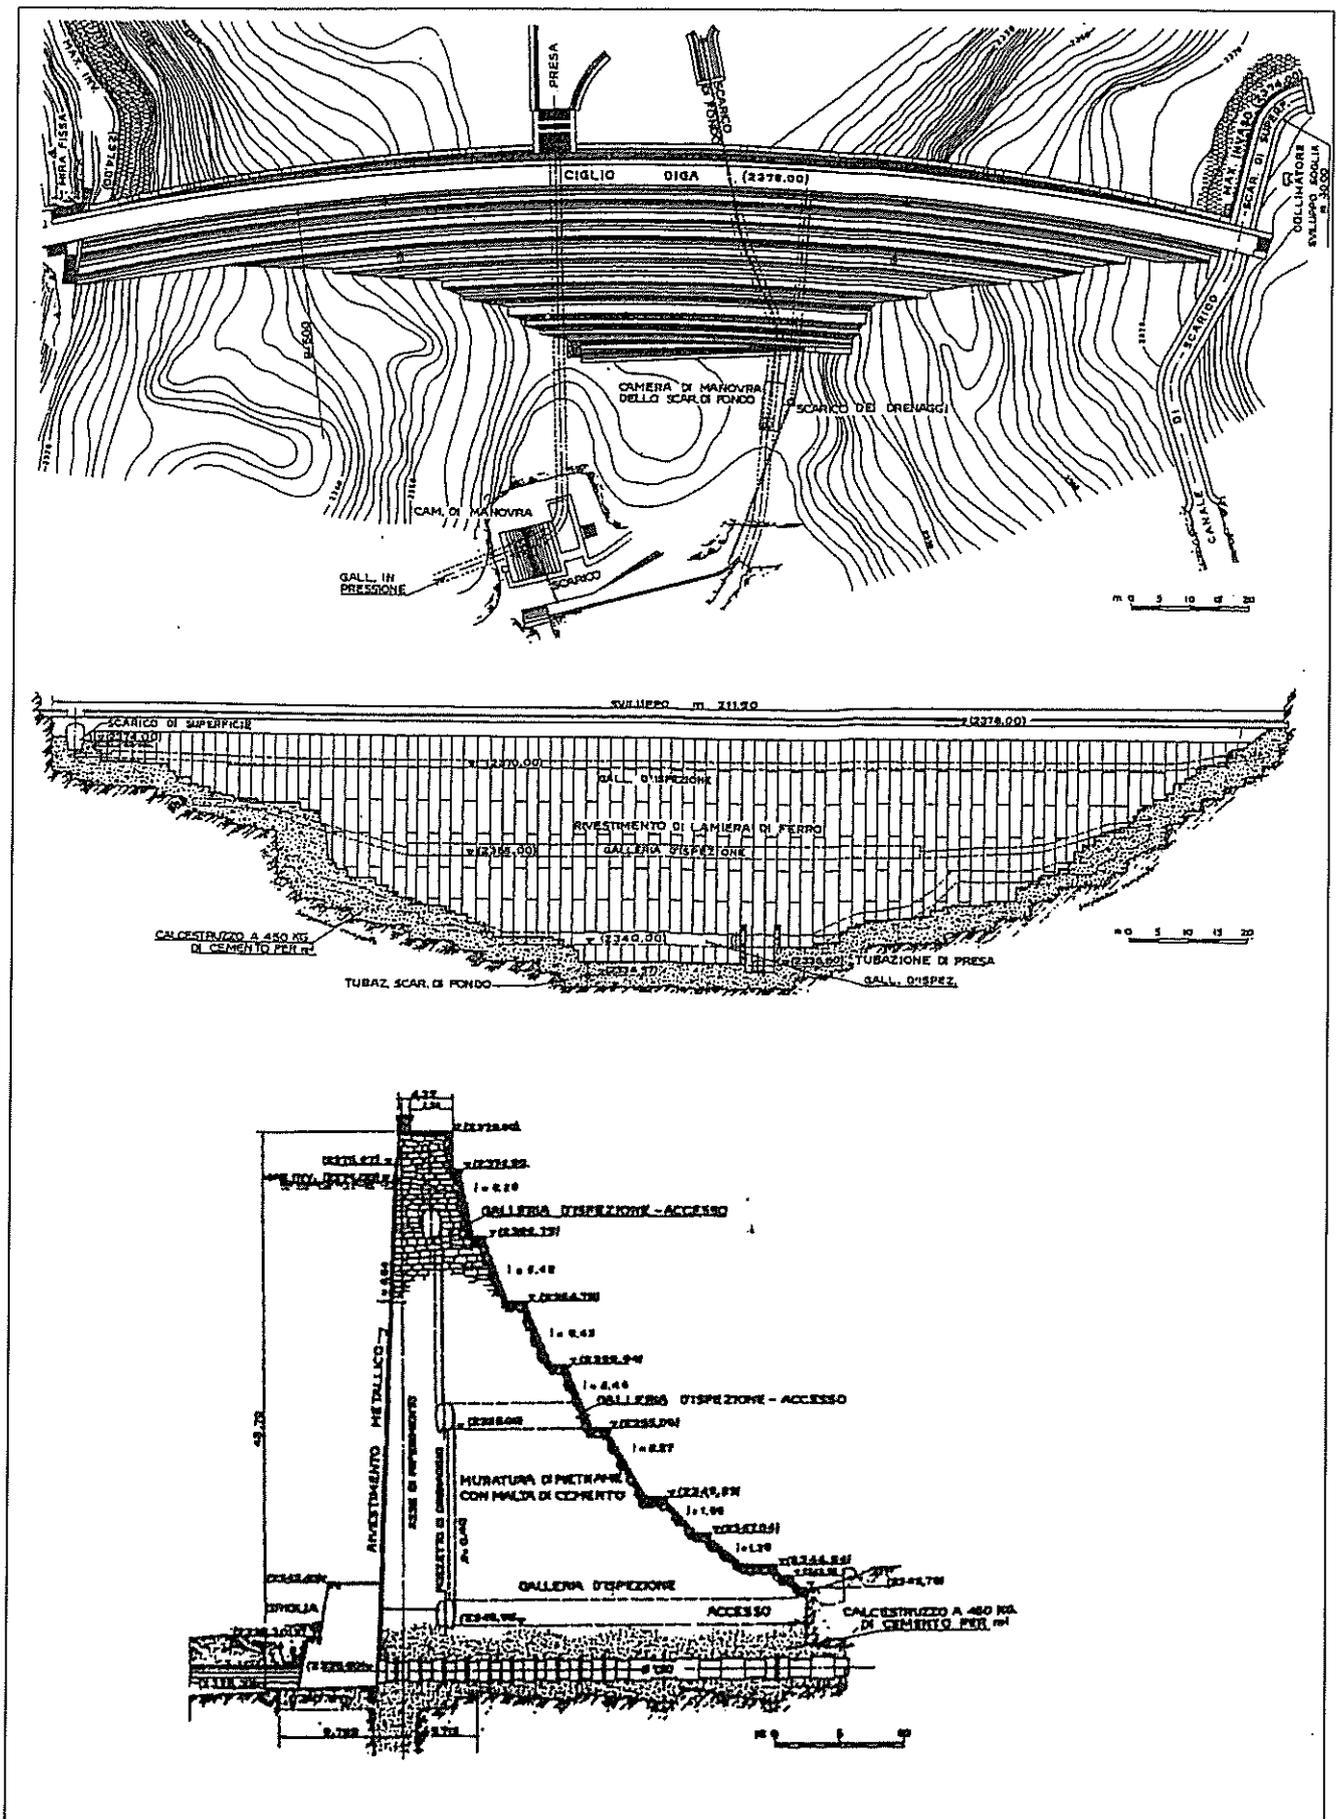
Diga Gabiet Sud: Planimetria - Vista da monte - Sezione tipo .
